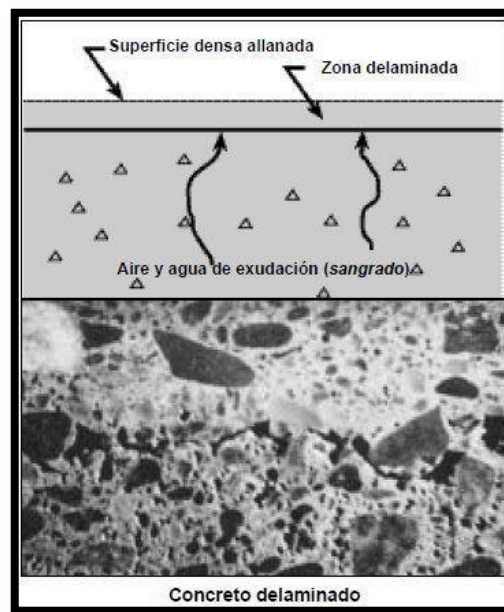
Esquema con fotografía estereoscópica de concreto con delaminación.
